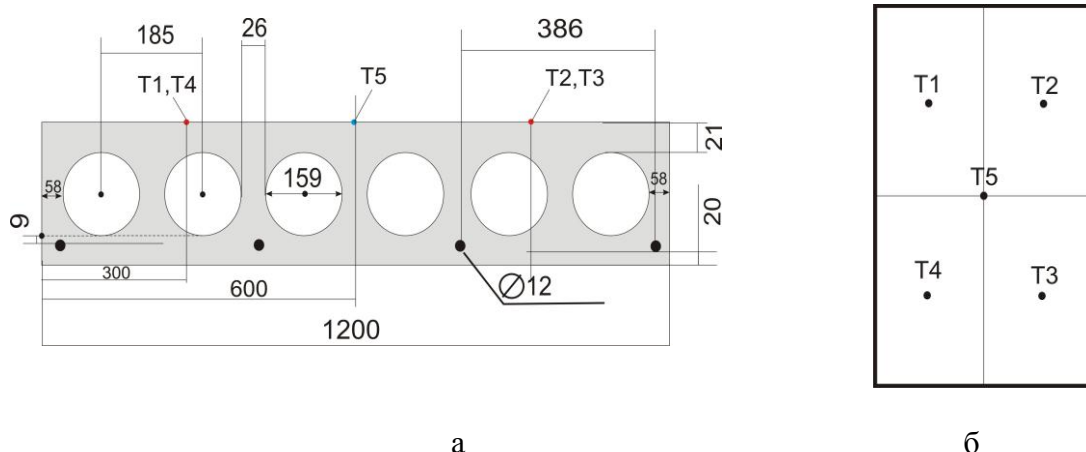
Схема расположения термопар с необогреваемой поверхностью многопустотного железобетонного перекрытия: а – вид спереди; б – вид сверху.
